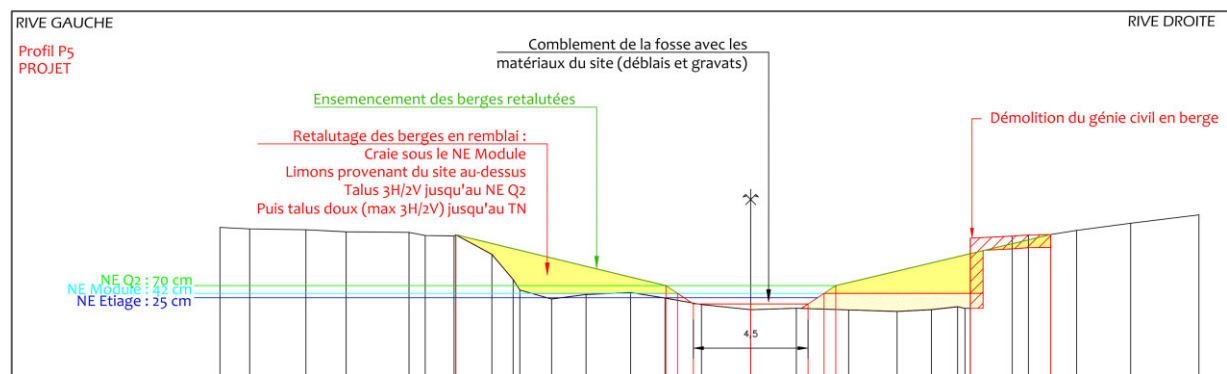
Profil en travers type appliqué en aval de l'ouvrage
